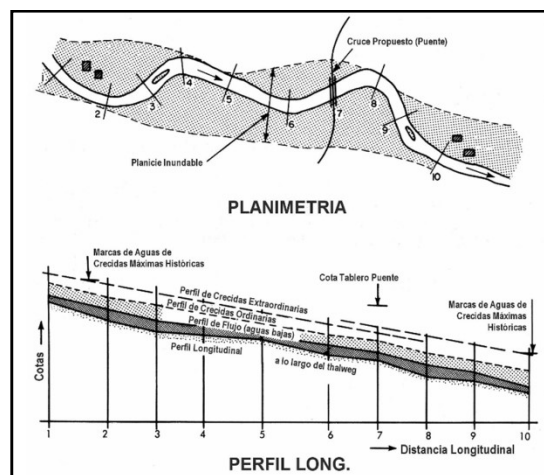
Planta y Perfil Longitudinal de secciones necesarias para la modelación
